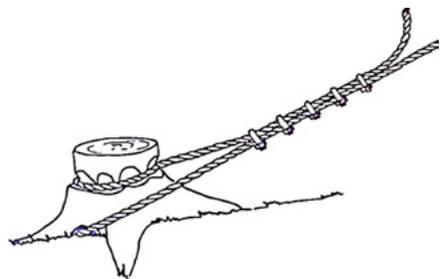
Seilverankerung an einem Wurzelstock (Schweizer Armee)
